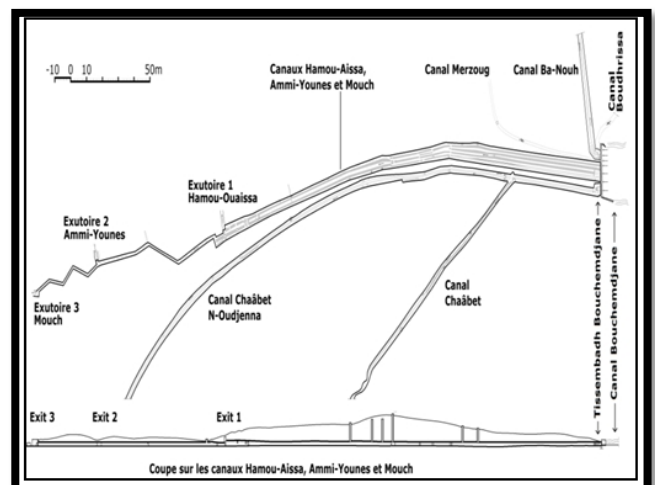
Plan des canaux de partage du canal Bouchene avec coupe de profil du groupe de canaux Hamou-Ouaïssa, Ammi-Younes et Mouch avec leurs puits d'aération.
